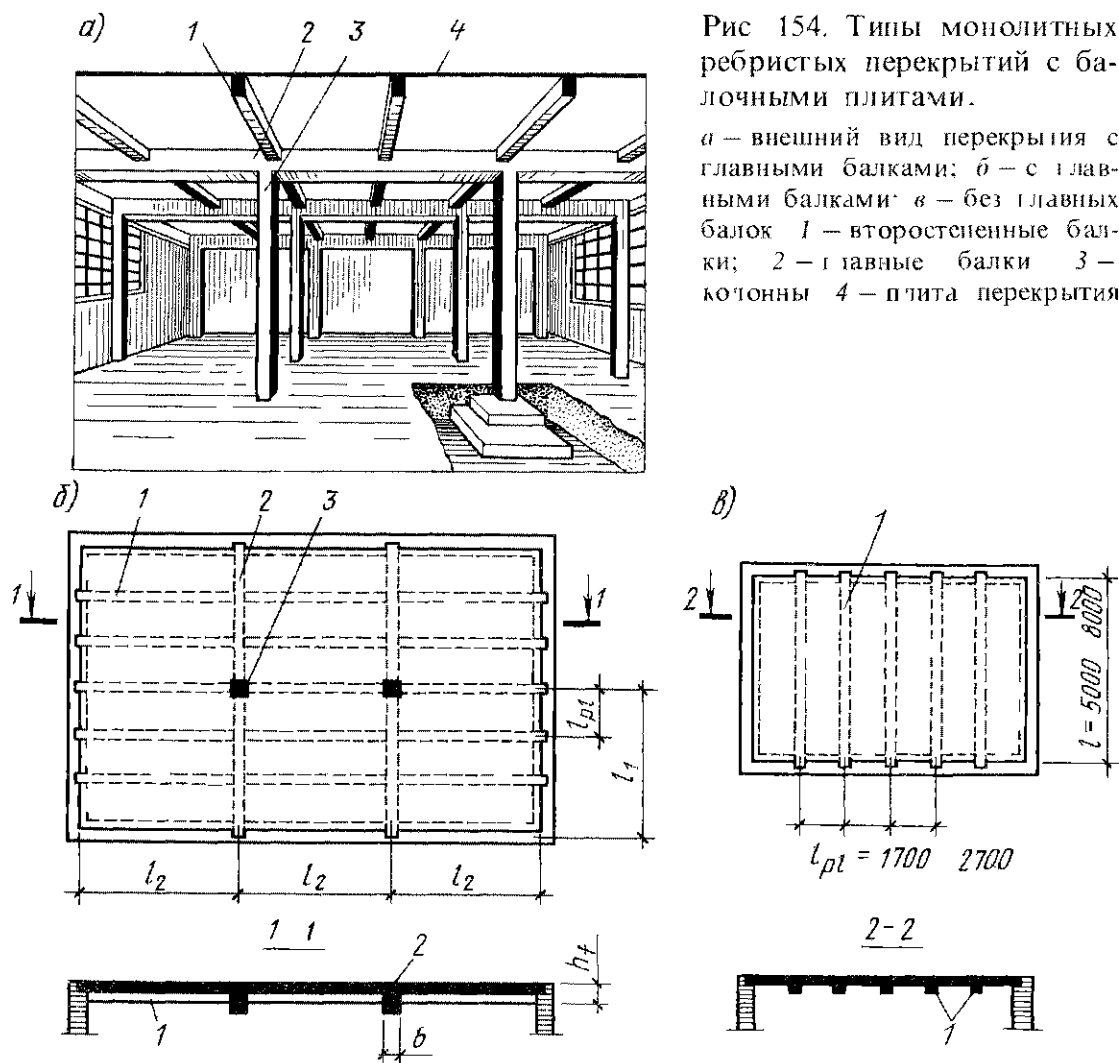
Типы монолитных ребристых перекрытий с балочными плитами.
